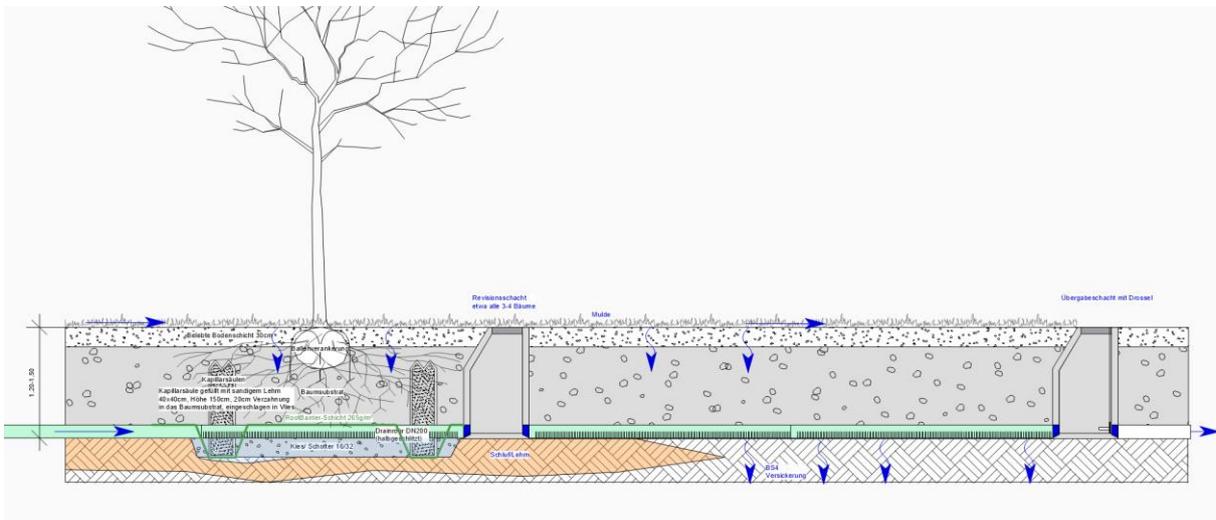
Längsschnitt Baumstandorte Straßenabschnitt 2 Planstatt Senner GmbH
